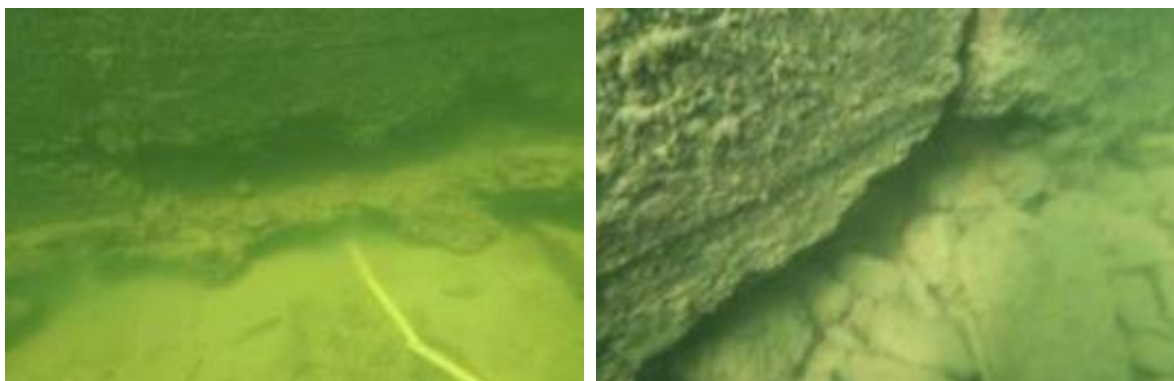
Exemples de désordres immergés - Affouillement en pied de mur (à gauche) et éclatement du béton (à droite)
